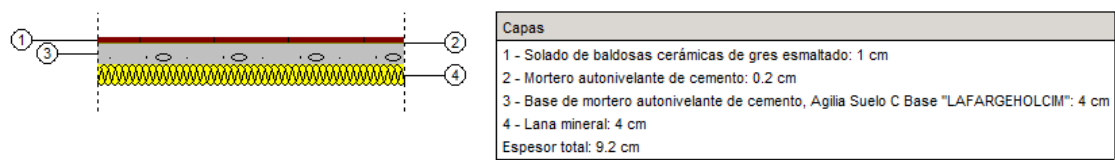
Detalle Pavimento Gres. Fuente: Programa CypeMEP
